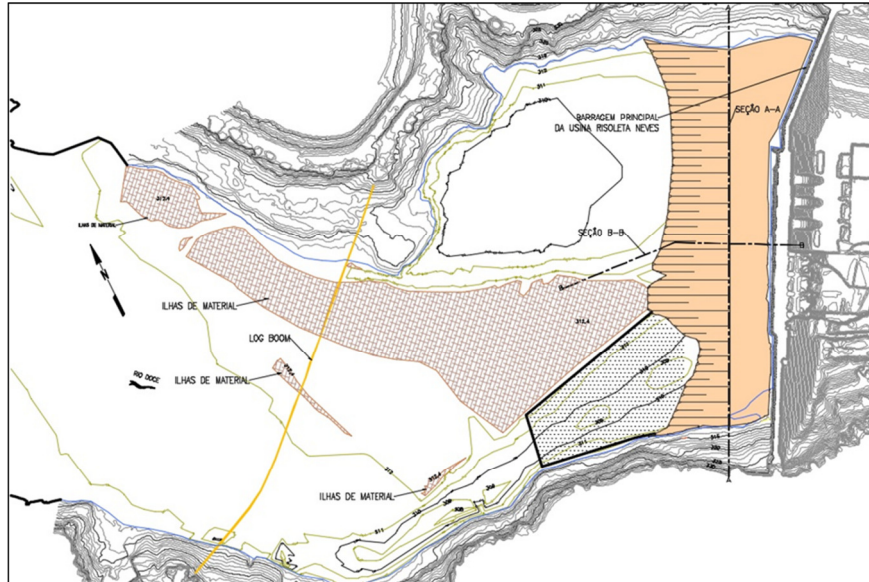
Planta de dragagem EL.308 – Fase 1 - 1a Etapa
